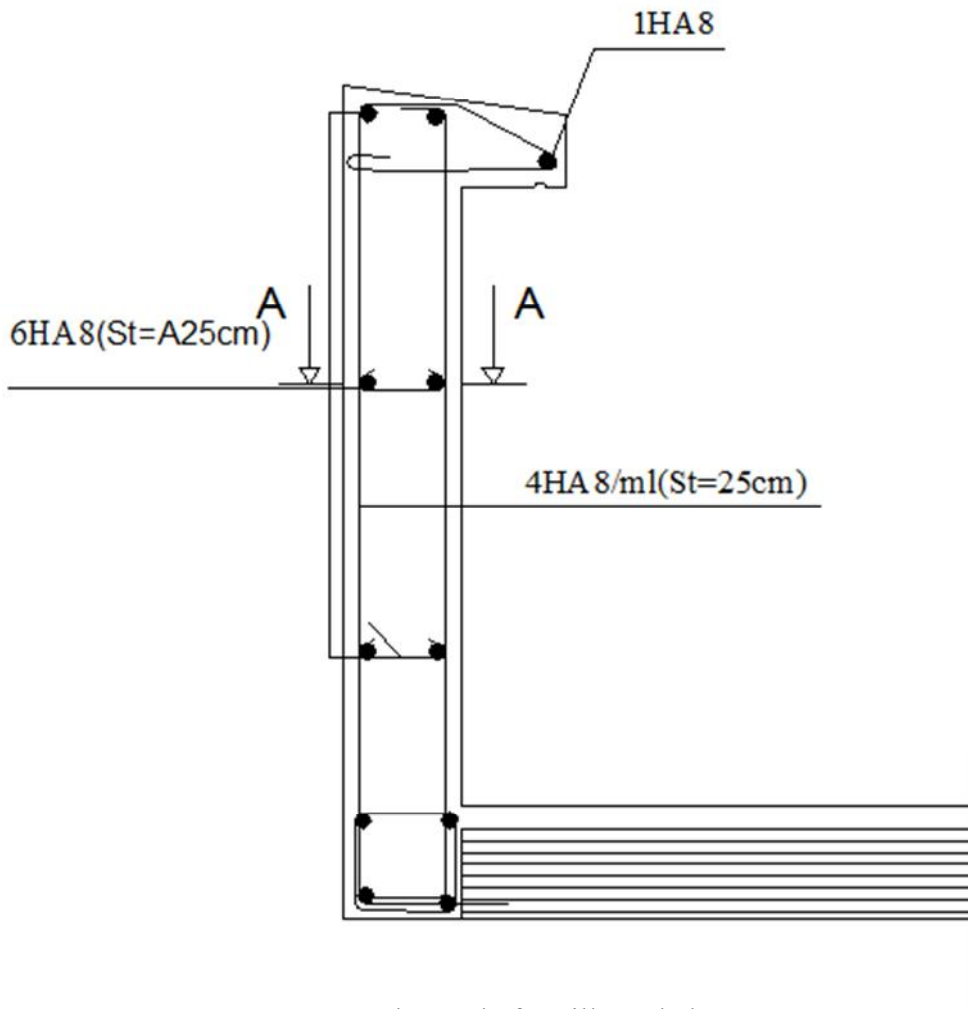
Schéma de ferrailage de l'acrotère
